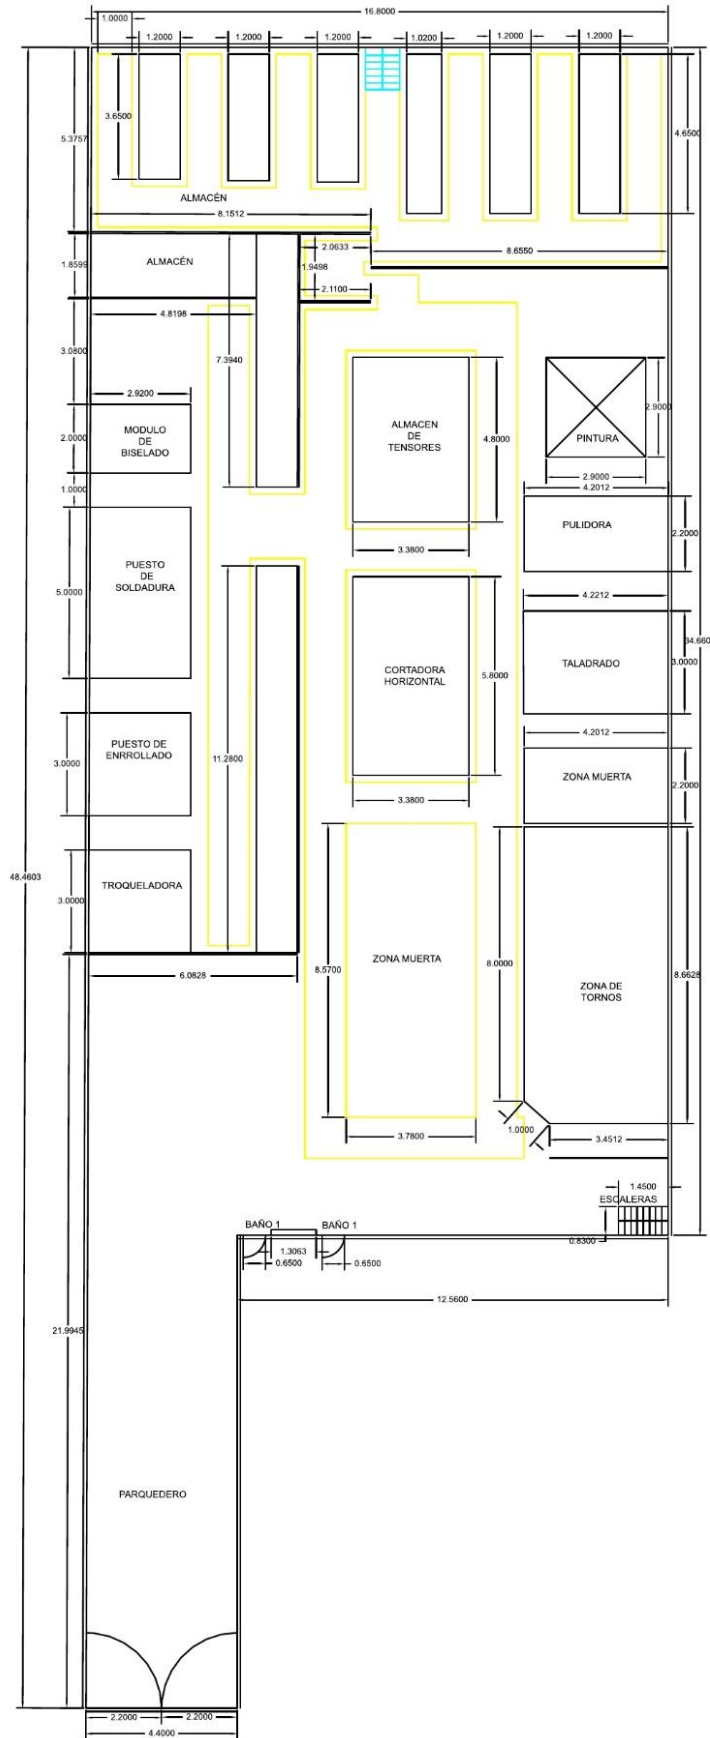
Distribución en planta. Planta No. 3 (Elaboración propia)
